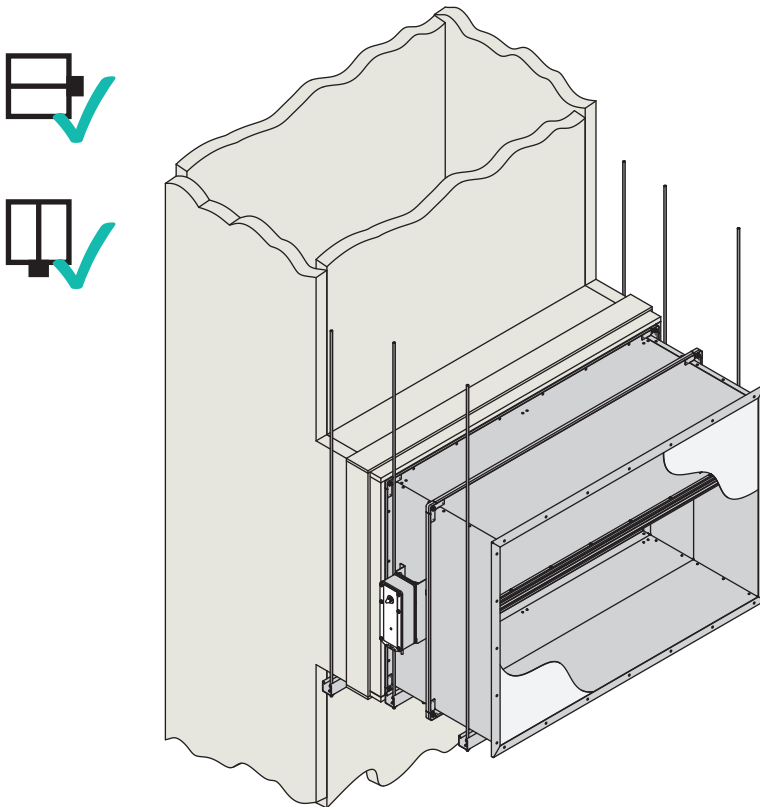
Installation des S-SA2L auf einem vertikalen Kanal mit horizontalen Anschluss
